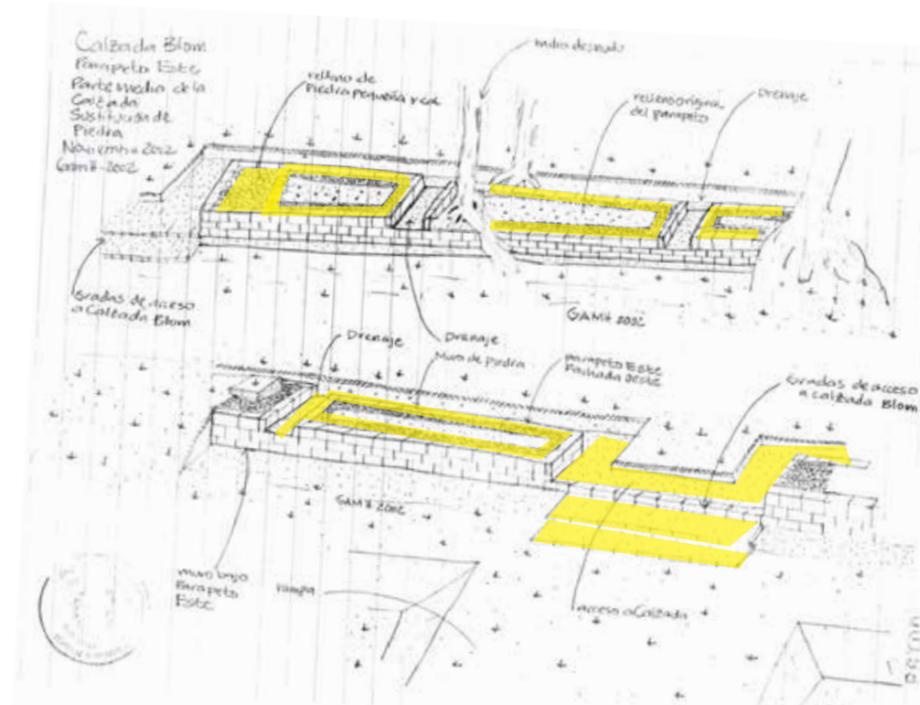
Dibujo Calzada Blom. Proceso de restauración del parapeto este. Integración de piedra y núcleo constructivo del parapeto. Dibujo: GAMH 2002
